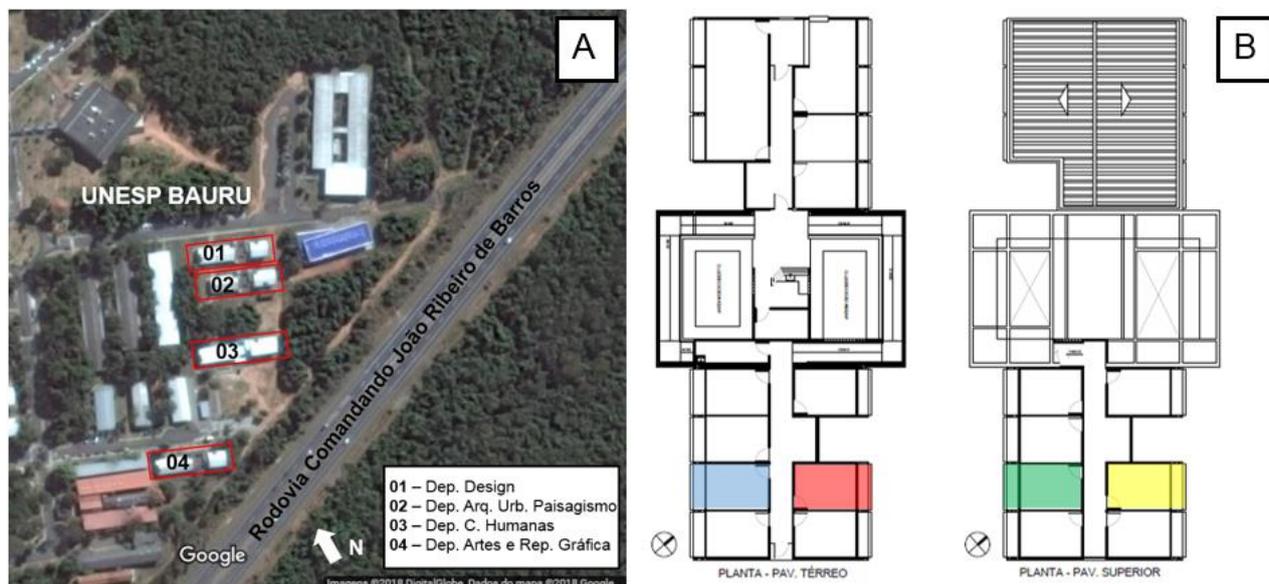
a) Localização dos departamentos; b) Planta baixa do departamento
